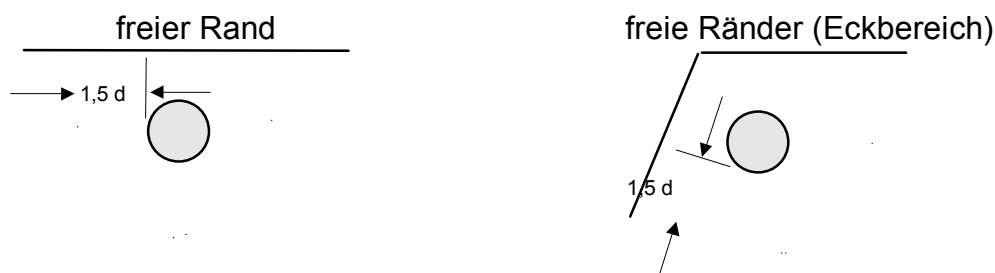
Grundriss für die Führung des „kritischen Rundschnittes“ um eine Lasteinleitungsstelle (schattierte Fläche) im Bereich freier Ränder nach DIN 1045-1 und EC2
